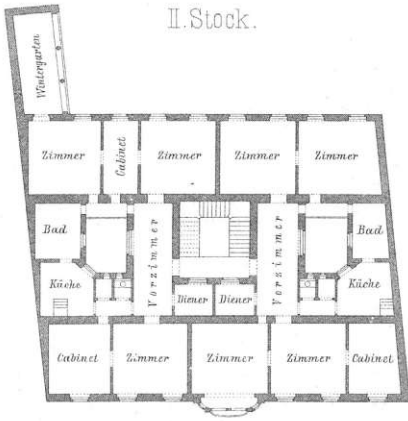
Grundrisse Alleegasse 21 - Heinrich Adam, 1885
